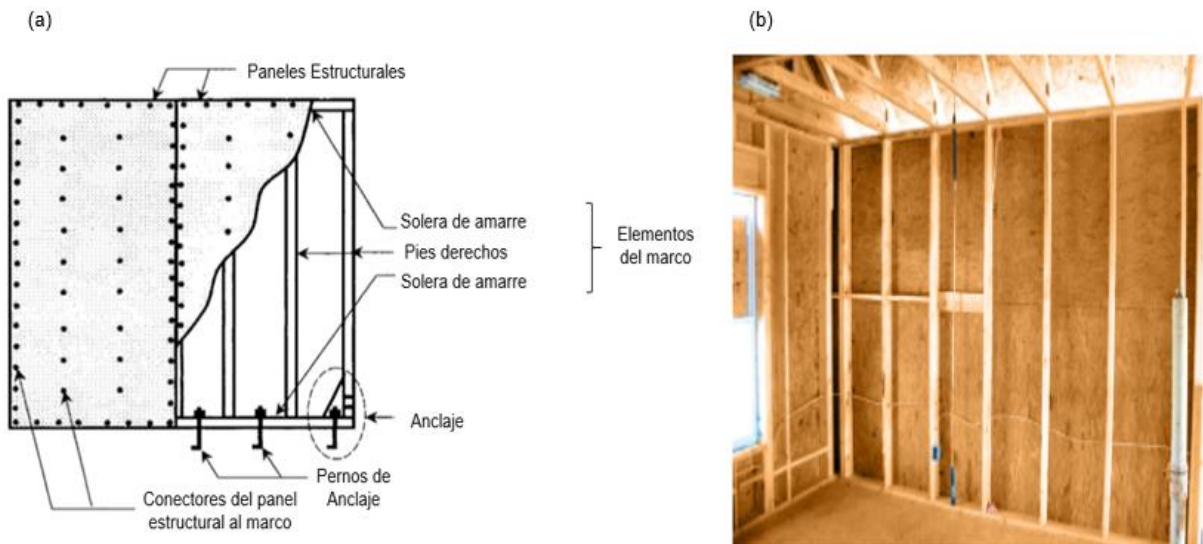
Muro de LTF: (a) Componentes de un muro LTF [18]; (b) Foto de un panel construido [18]
